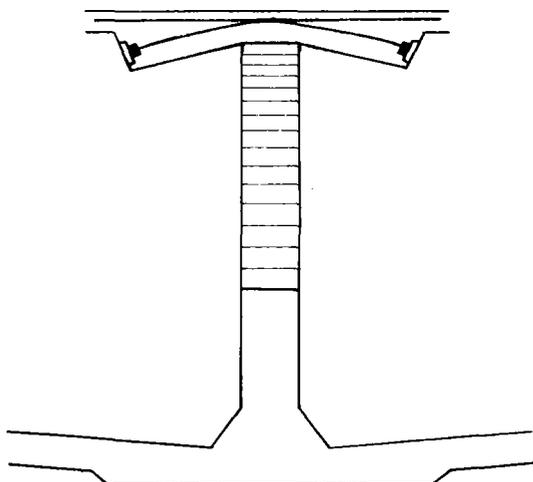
Ancrages des câbles de continuité supérieurs au voisinage de l'entretoise.
